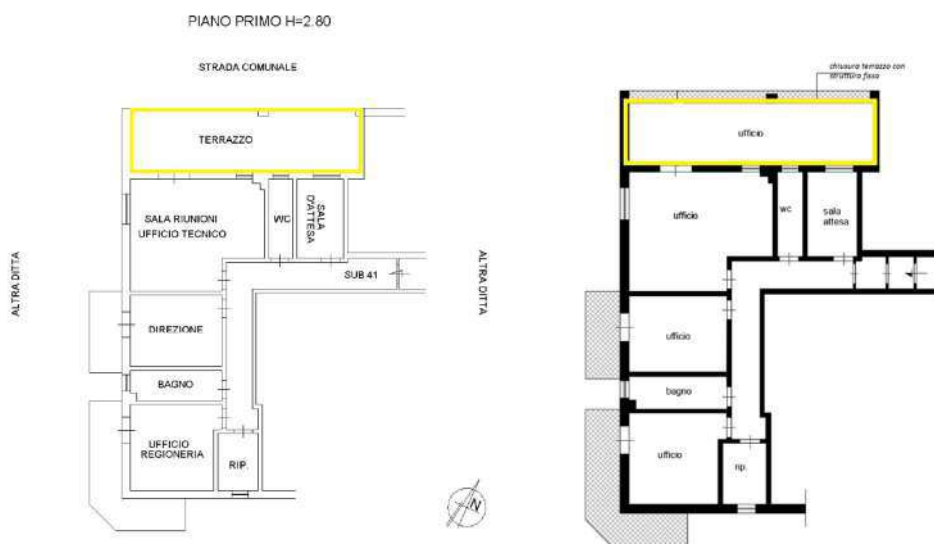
Confronto planimetria catastale-planimetria stato attuale
